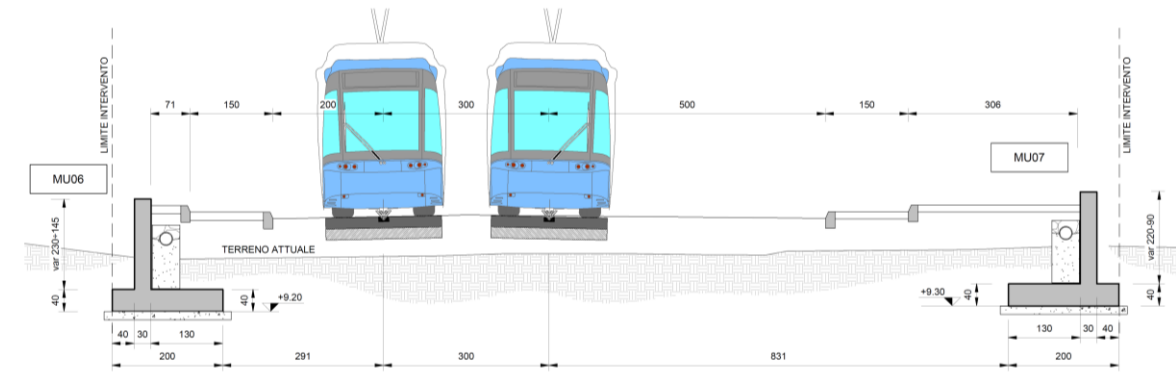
Sezione trasversale muri di sostegno MU06-07
